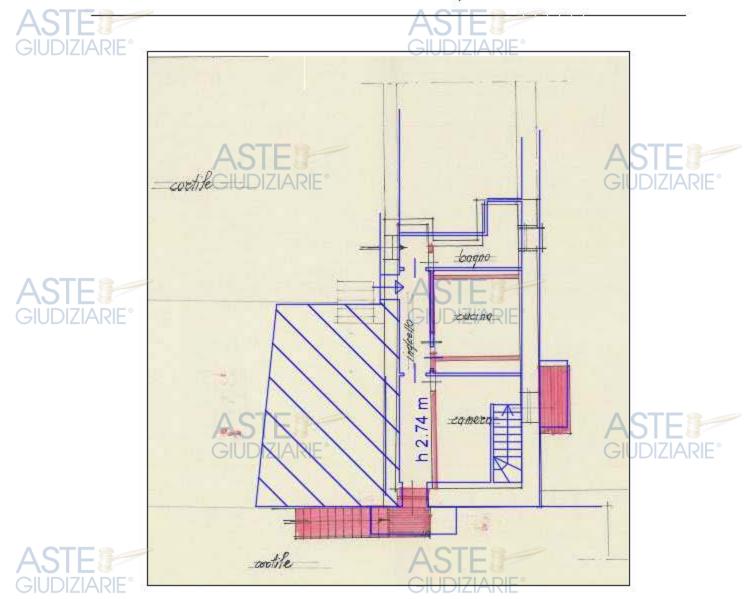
Estratto planimetria piano rialzato allegata a pratica di condono 345/87 con sovrapposizione rilievo stato di fatto rappresentato con linea blu
